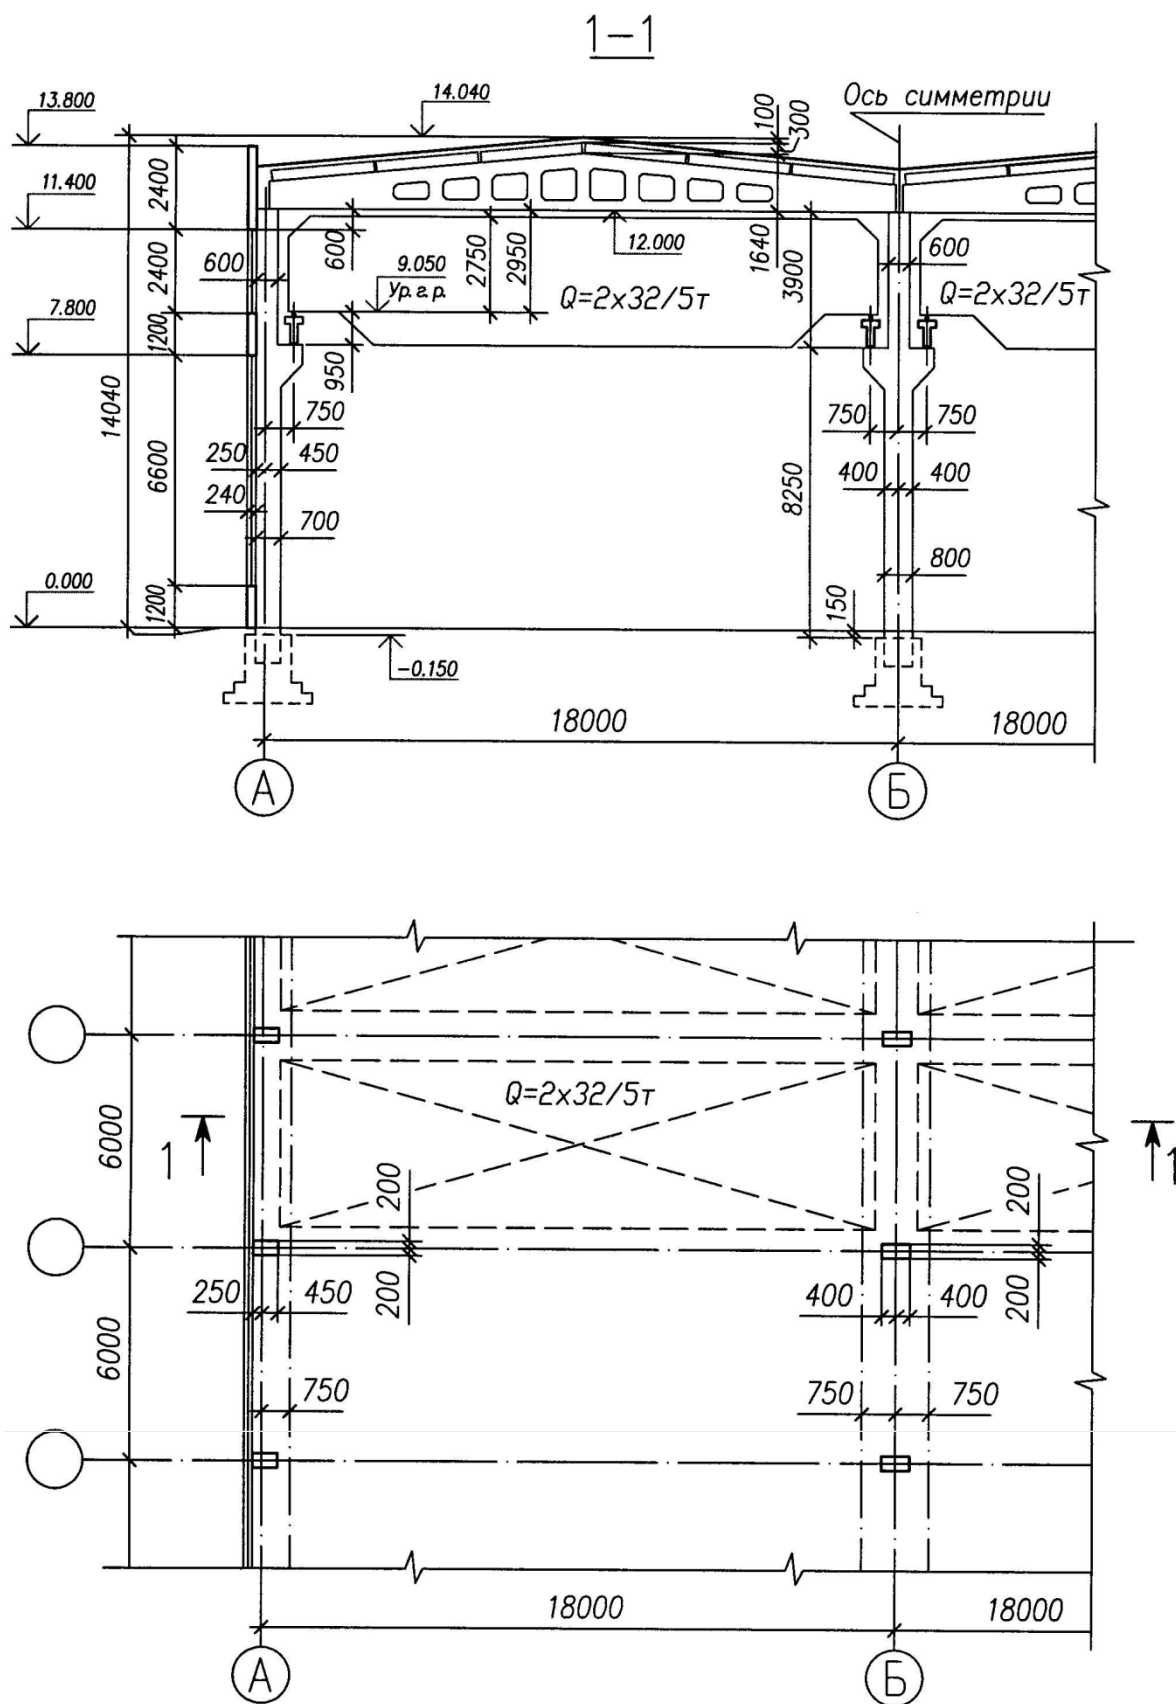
Поперечный разрез и фрагмент плана одноэтажного двухпролетного промышленного здания
